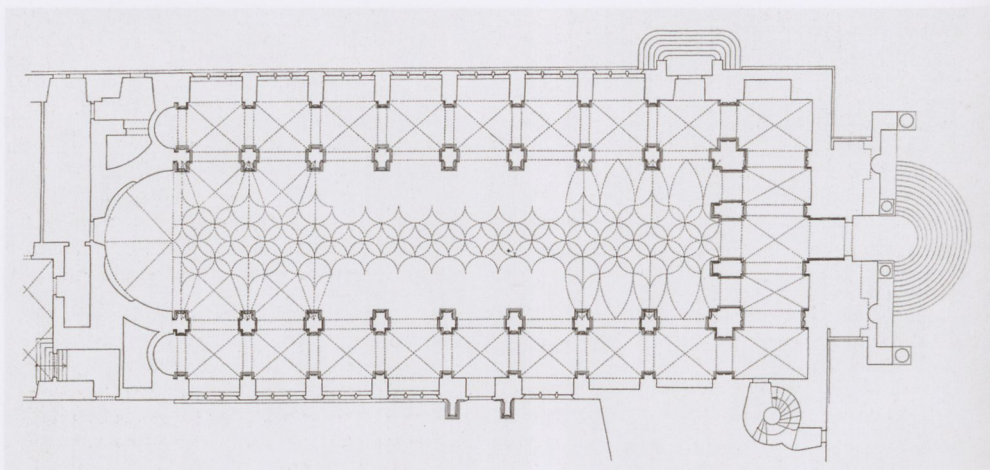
Würzburg, Universitätskirche, Grundriss mit einem von Reinhard Helm rekonstruierten Wölbriss zum ehemaligen Schlingrippengewölbe der Neubaukirche
